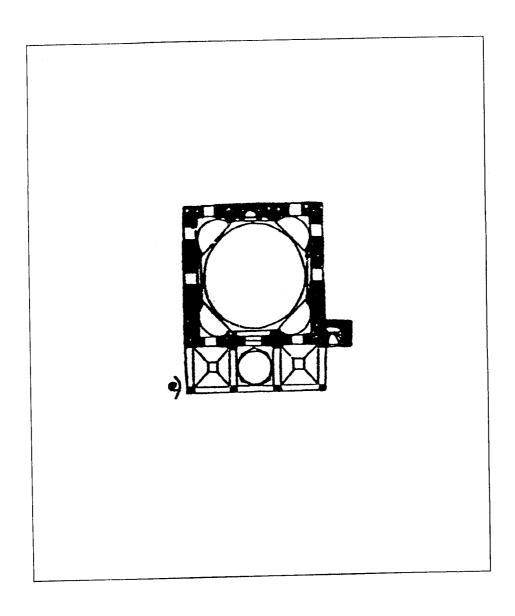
مسقط أفقي لمسجد مصطفى باشا في اسكوب (عن : ايفردى) .
